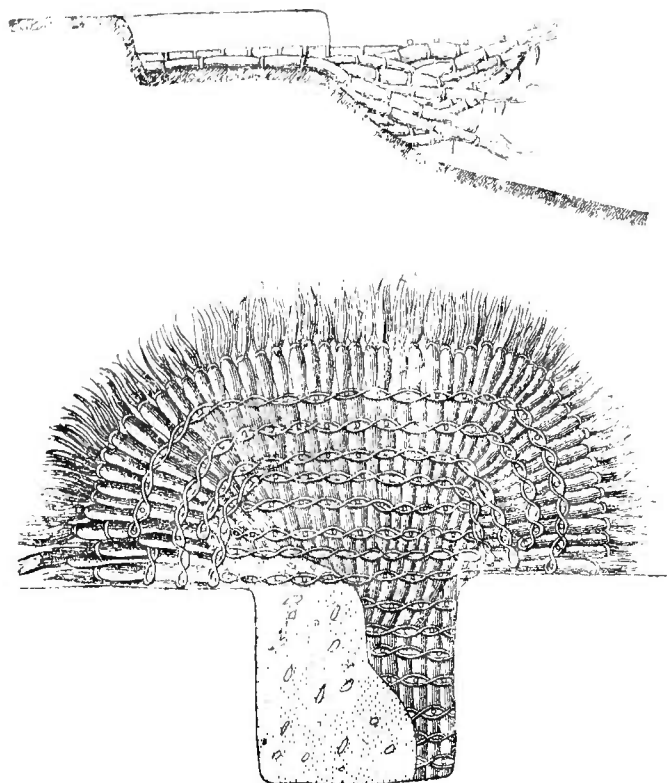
Fascinage à barbes et tunage de soutènement. Plan et coupe d'une première couche.
